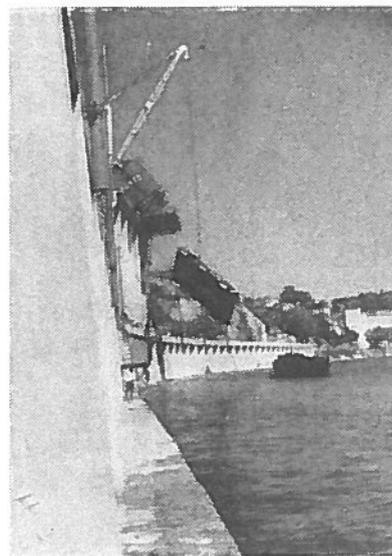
Montagem de um caixão do 3.º troço — Elevação
